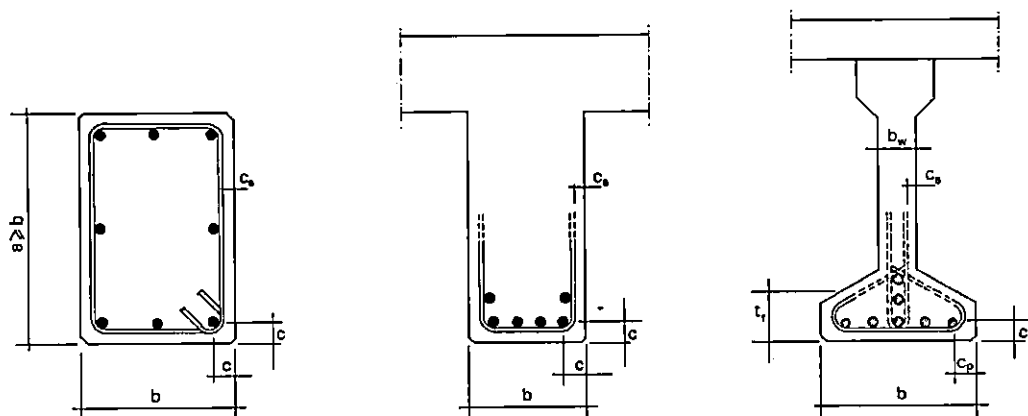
Sezioni di pilastri e travi in c.a. e c.a.p.
